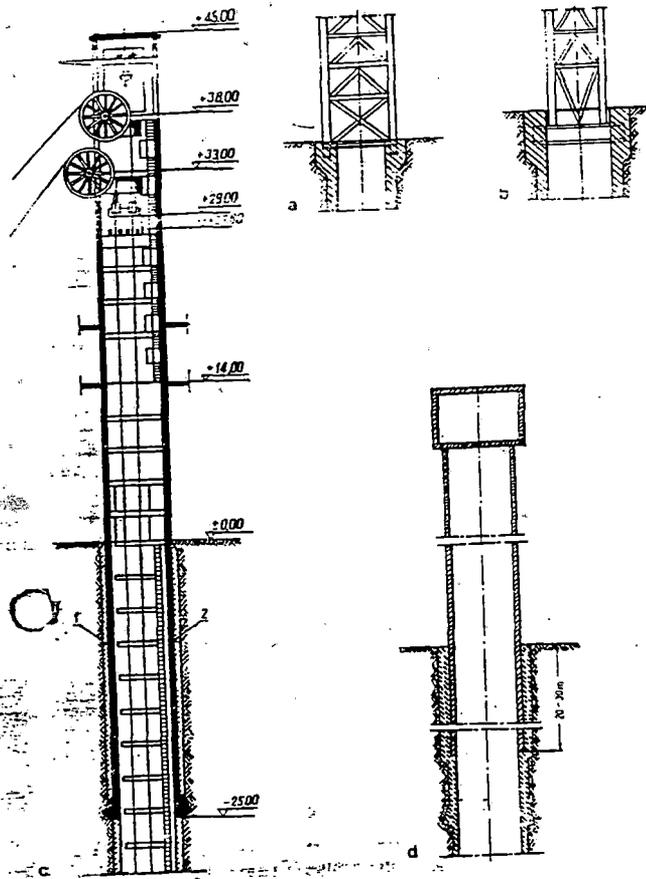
(a, b, c, d) Sección del Castillo y base de fundación. a) Fundación de la base del túnel. b) Fundación sobre la viga localizada en las paredes del collar c) Sección circular reforzada con concreto d) Sección del castillo y collar del pique.
